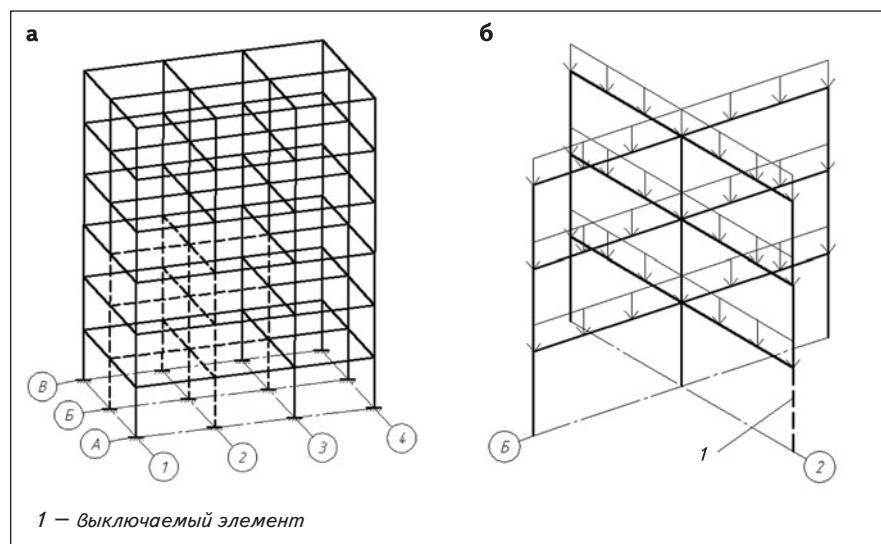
Расчетные схемы первого (а) и второго (б) уровней железобетонного монолитного многоэтажного здания
